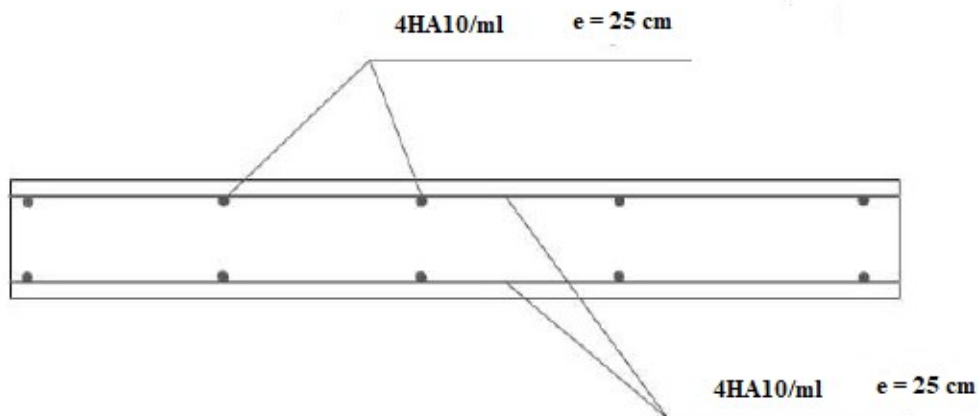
plan de ferrailage de la dalle triangulaire.
